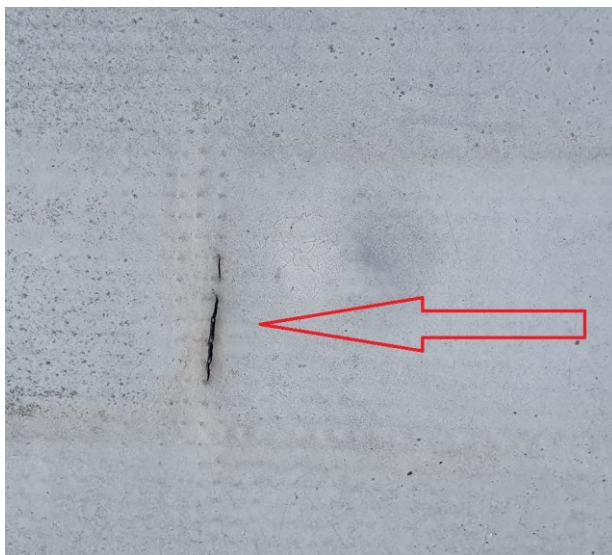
deformace folie PVC od atikové konstrukce – protržení spoje
